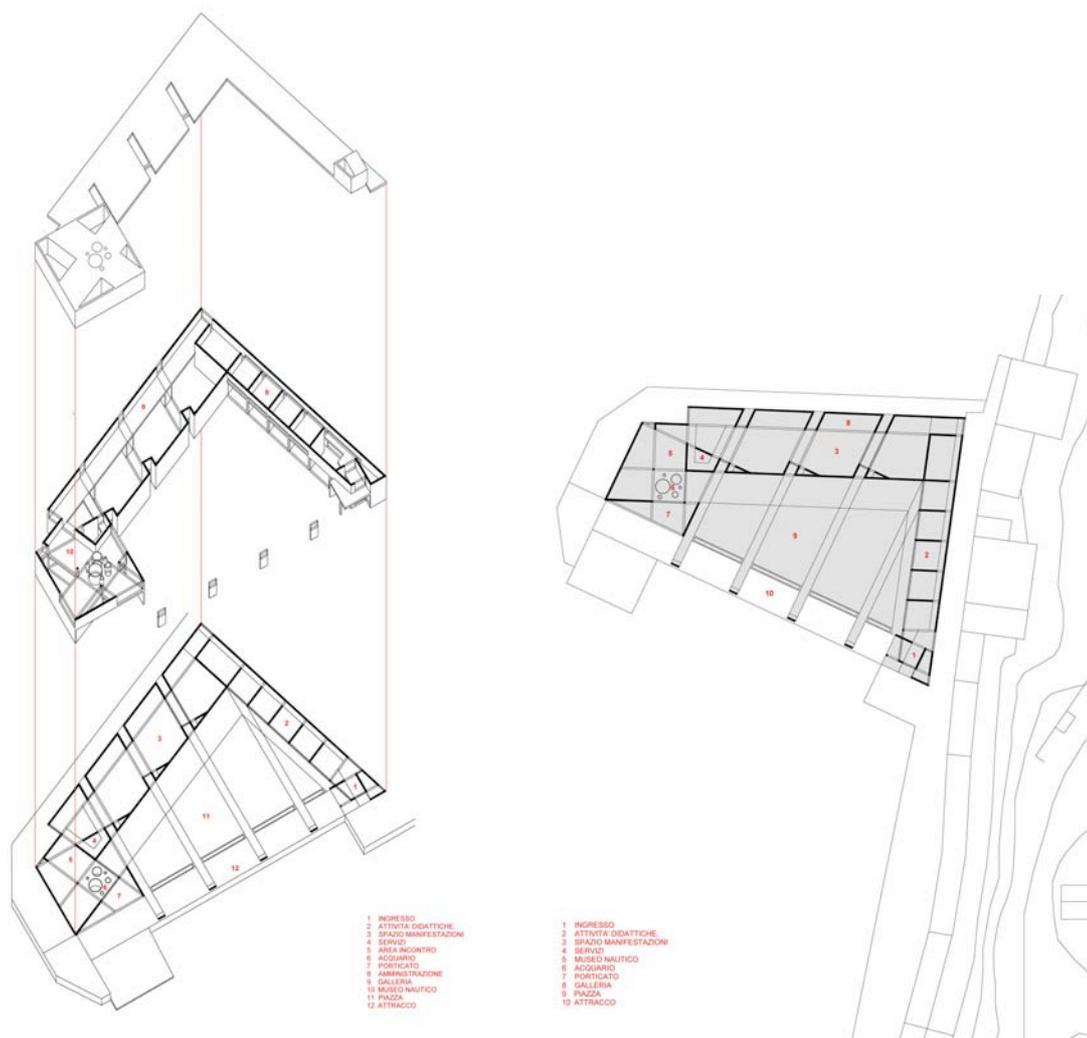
, 6. Porto d'Ischia, esploso assonometrico. Localizzazione e pianta del piano terreno del museo nautico, sull'area dell'ex-cantiere navale (Progetto A. Monaco)
